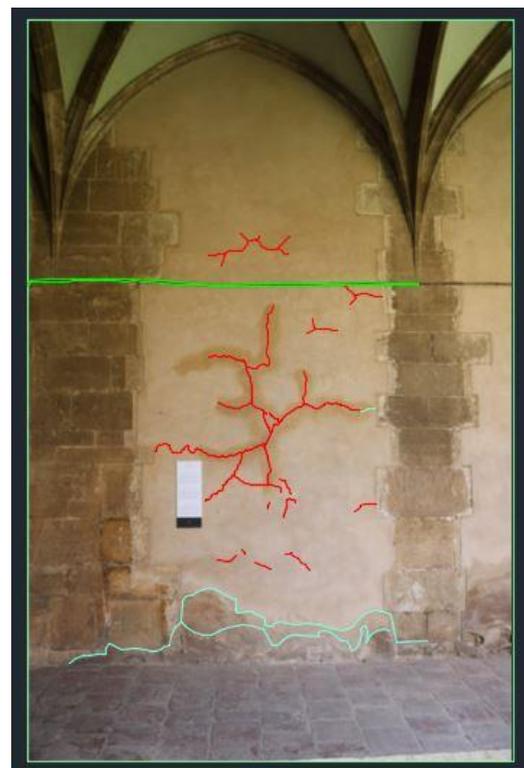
Fotogrametría en AutoCad de las patologías de una parte del alzado Sur del claustro.
